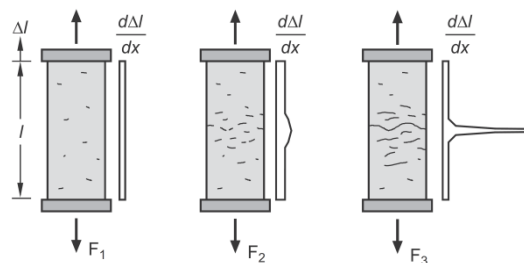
Beton unter Zugbeanspruchung – Lokalisierung der Rissbildung [Zilch & Zehetmaier (2010)]
